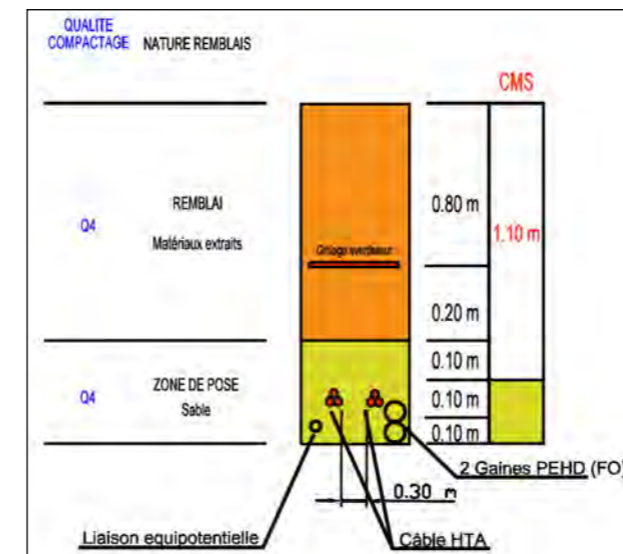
COUPES D'ENFOUSSEMENT TYPE DU CÂBLE
